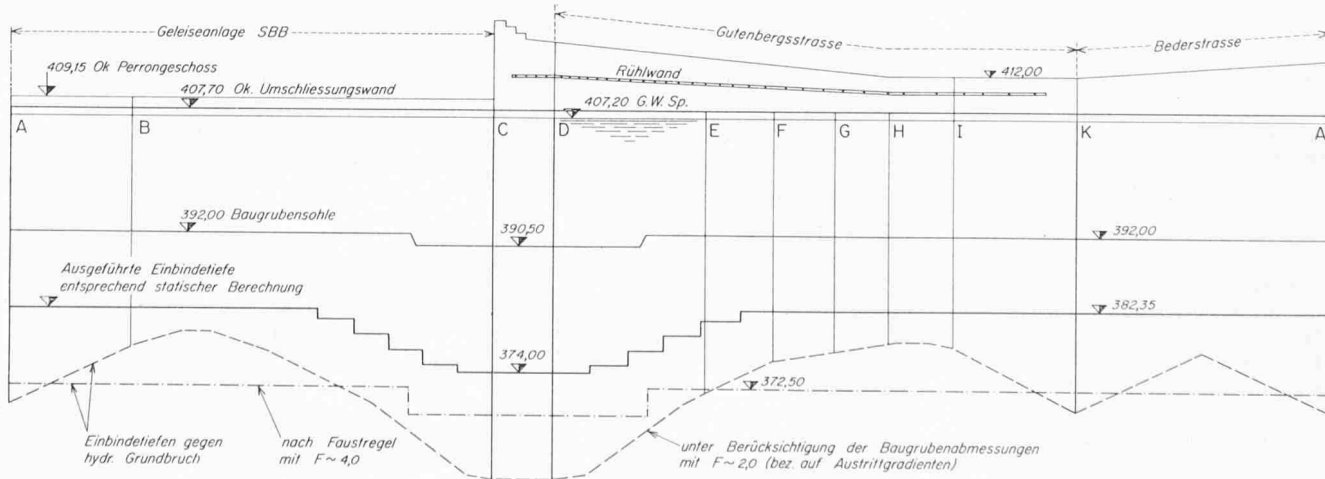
Abwicklung der Umschliessungswand mit Geländekoten. Gegenüberstellung der Ergebnisse zweier Grundbruchberechnungen. Massstab 1:1000
